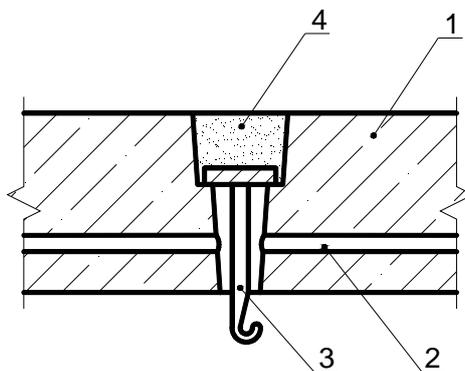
Схема конструктивного решения выпуска провода из перекрытия к потолочному светильнику (перекрытие со сквозным отверстием):
